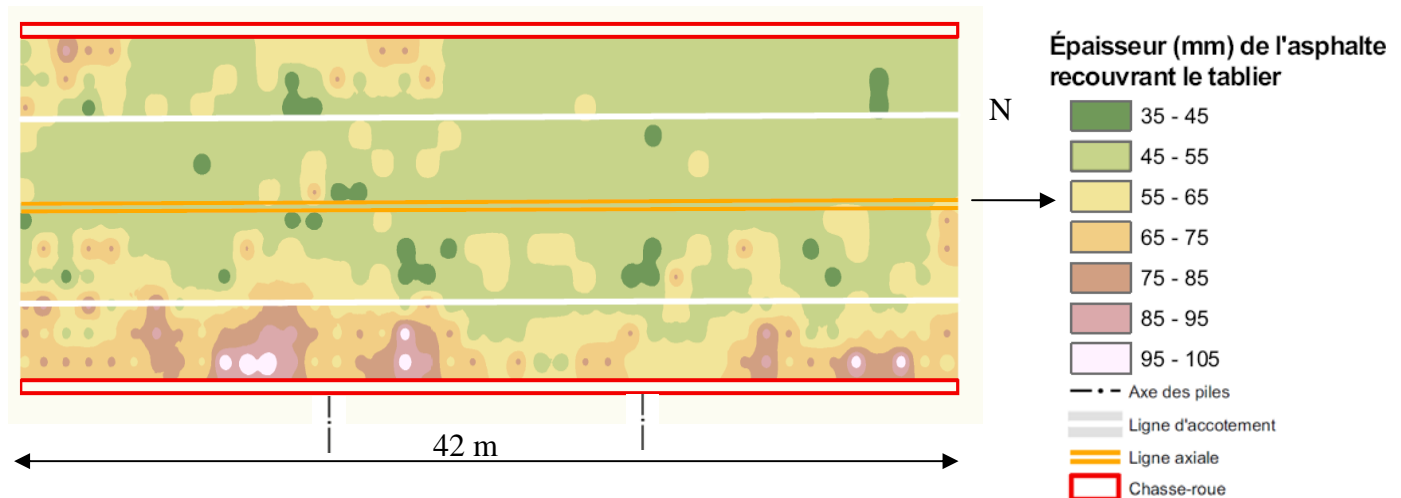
Épaisseur d'asphalte recouvrant la dalle du tablier du pont situé à St-Sixte
